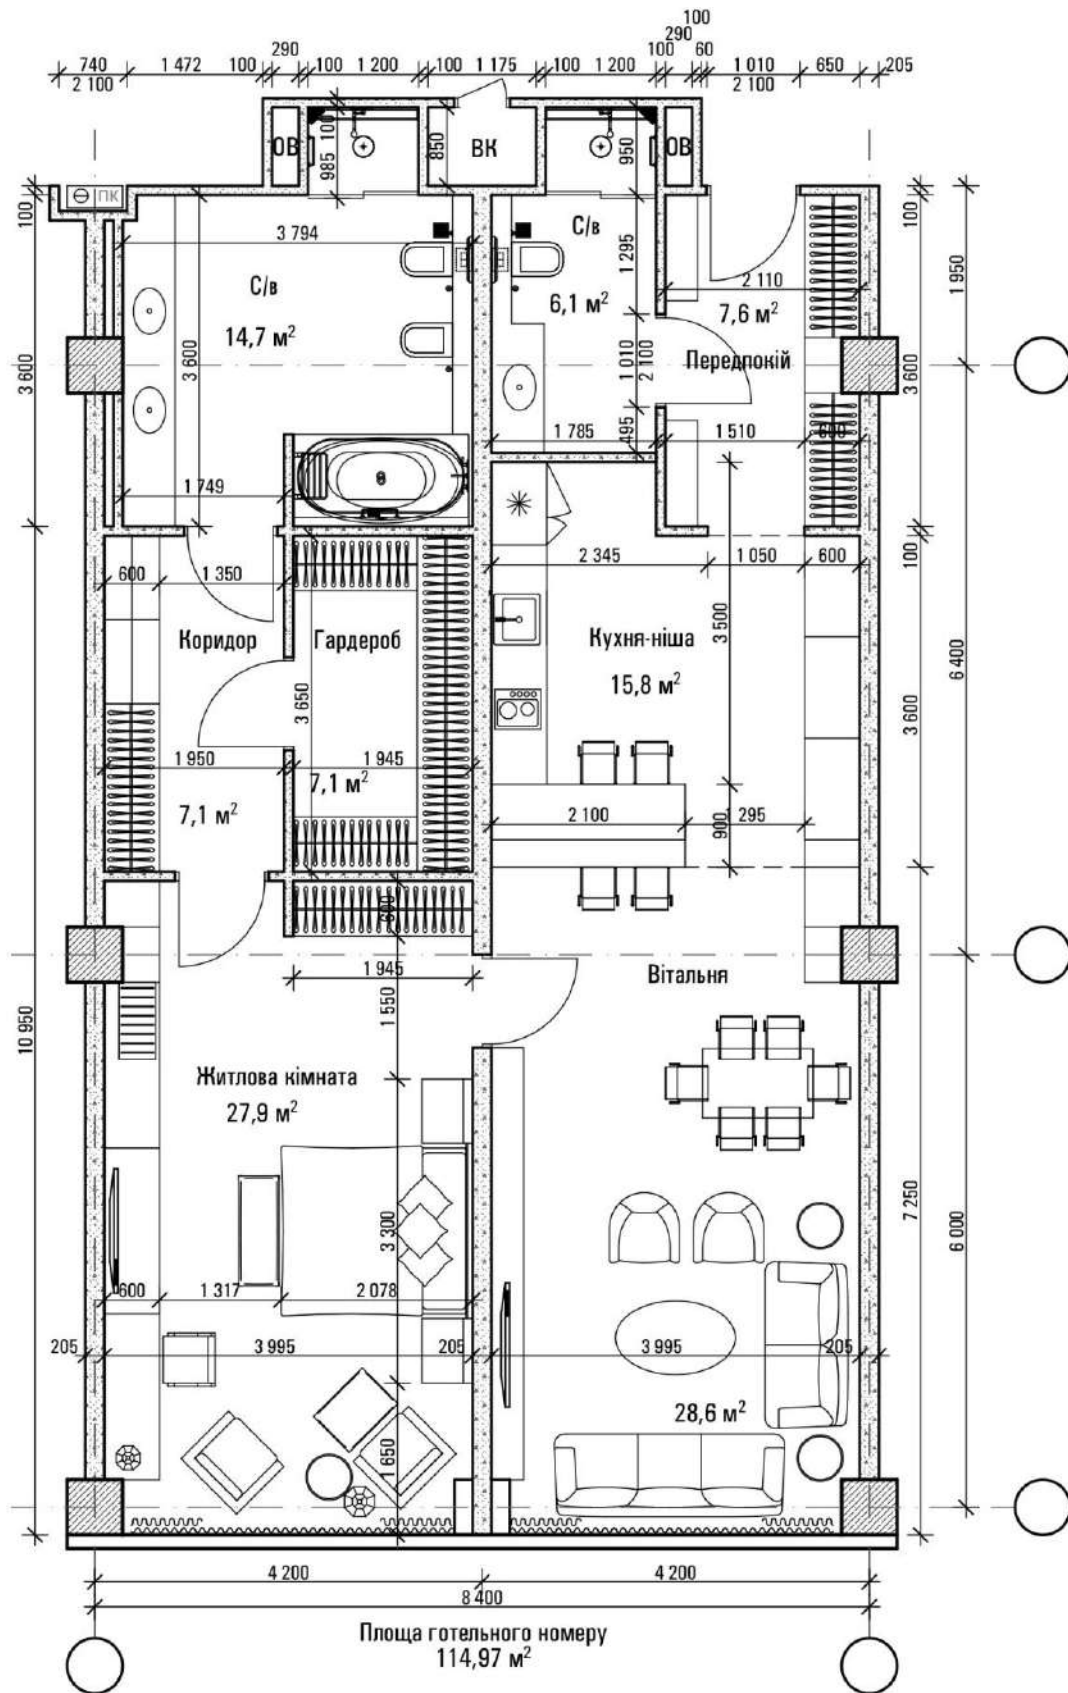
Планувальне рішення двокімнатних житлових апартаментів. [Авторське креслення]
